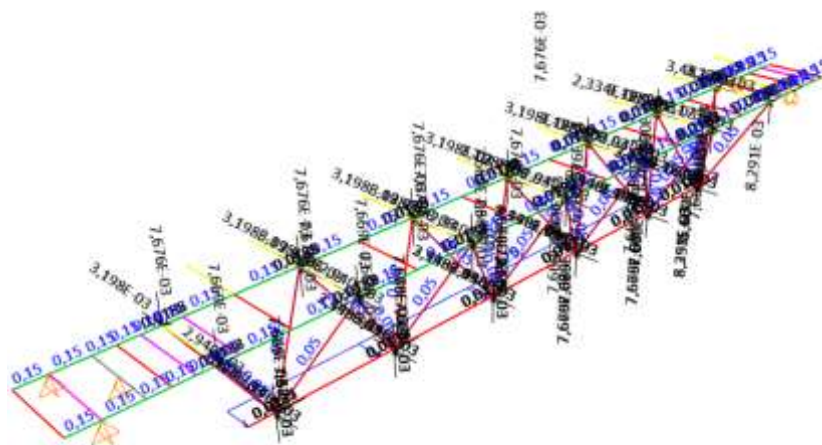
Beban Angin (WZ) yang diterima Struktur *Catwalk 12
